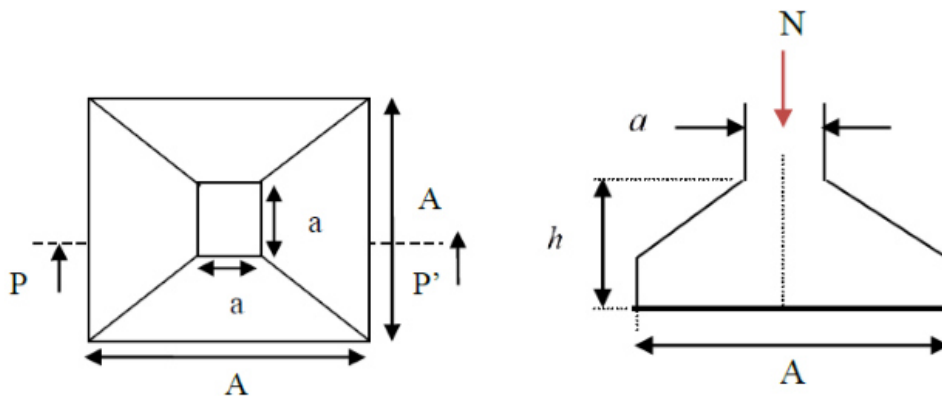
vue en plan et coup p-p de la semelle isolée
